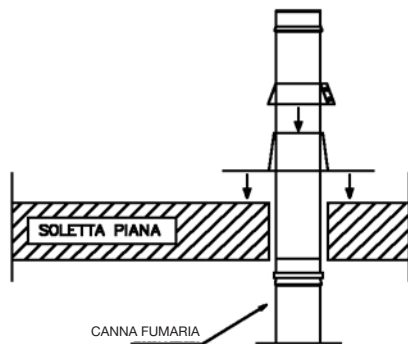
B Schema di montaggio del faldale piano con fascetta per faldale
